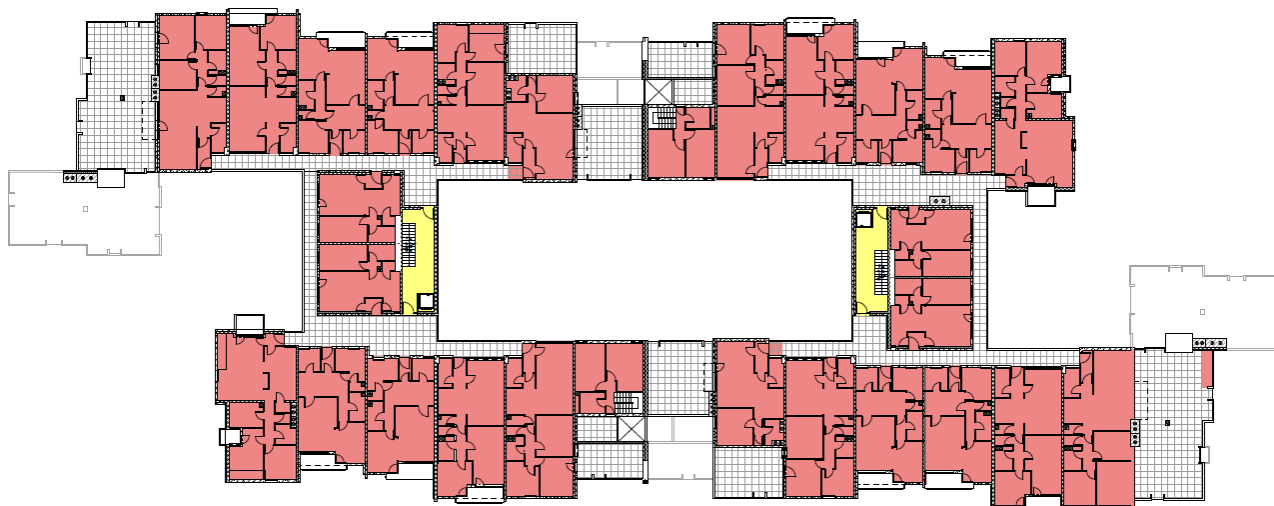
Projektna dokumentacija – shema zona – prizemlje
